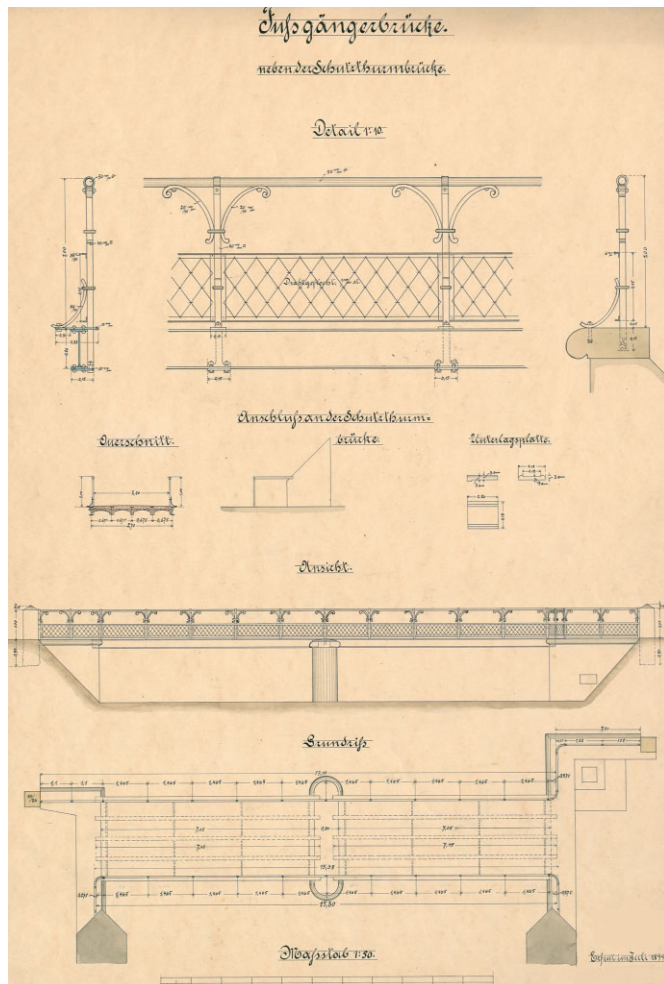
Fußgängerbrücke neben der Schutzturmschleuse, dem ehemaligen Einlauf der Wilden Gera in das Stadtgebiet – Bauwerksplan – HERMANN KICKTON – 1899
